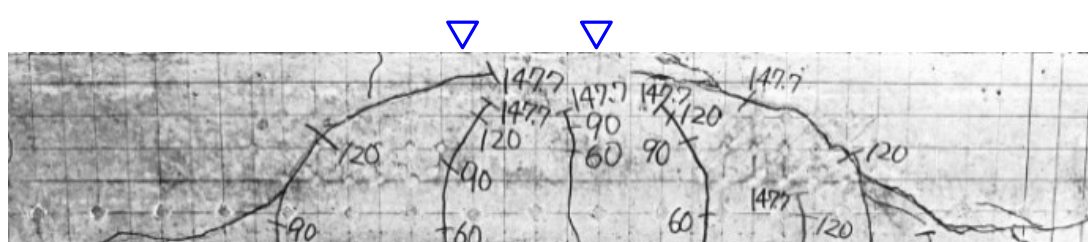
膨張 Ps1.5%-250A ひび割れ状況（斜め引張破壊例）
